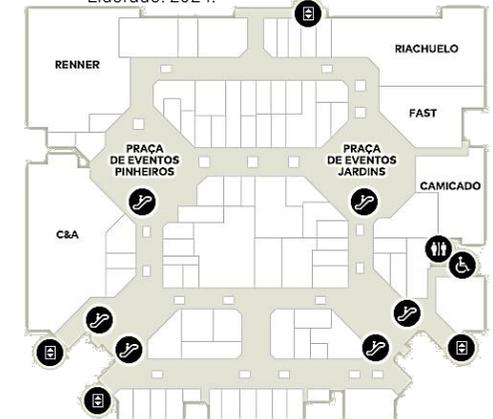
Planta Piso 01 - Fonte: Shopping Eldorado. 2024.
